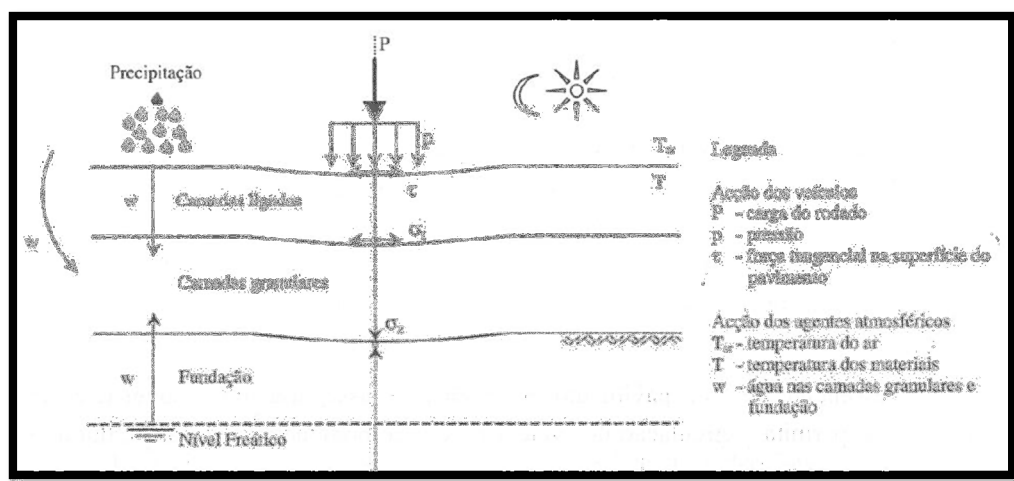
1 - Pavimento Rodoviário: constituição e ações (Branco *et al.*, 2008)
